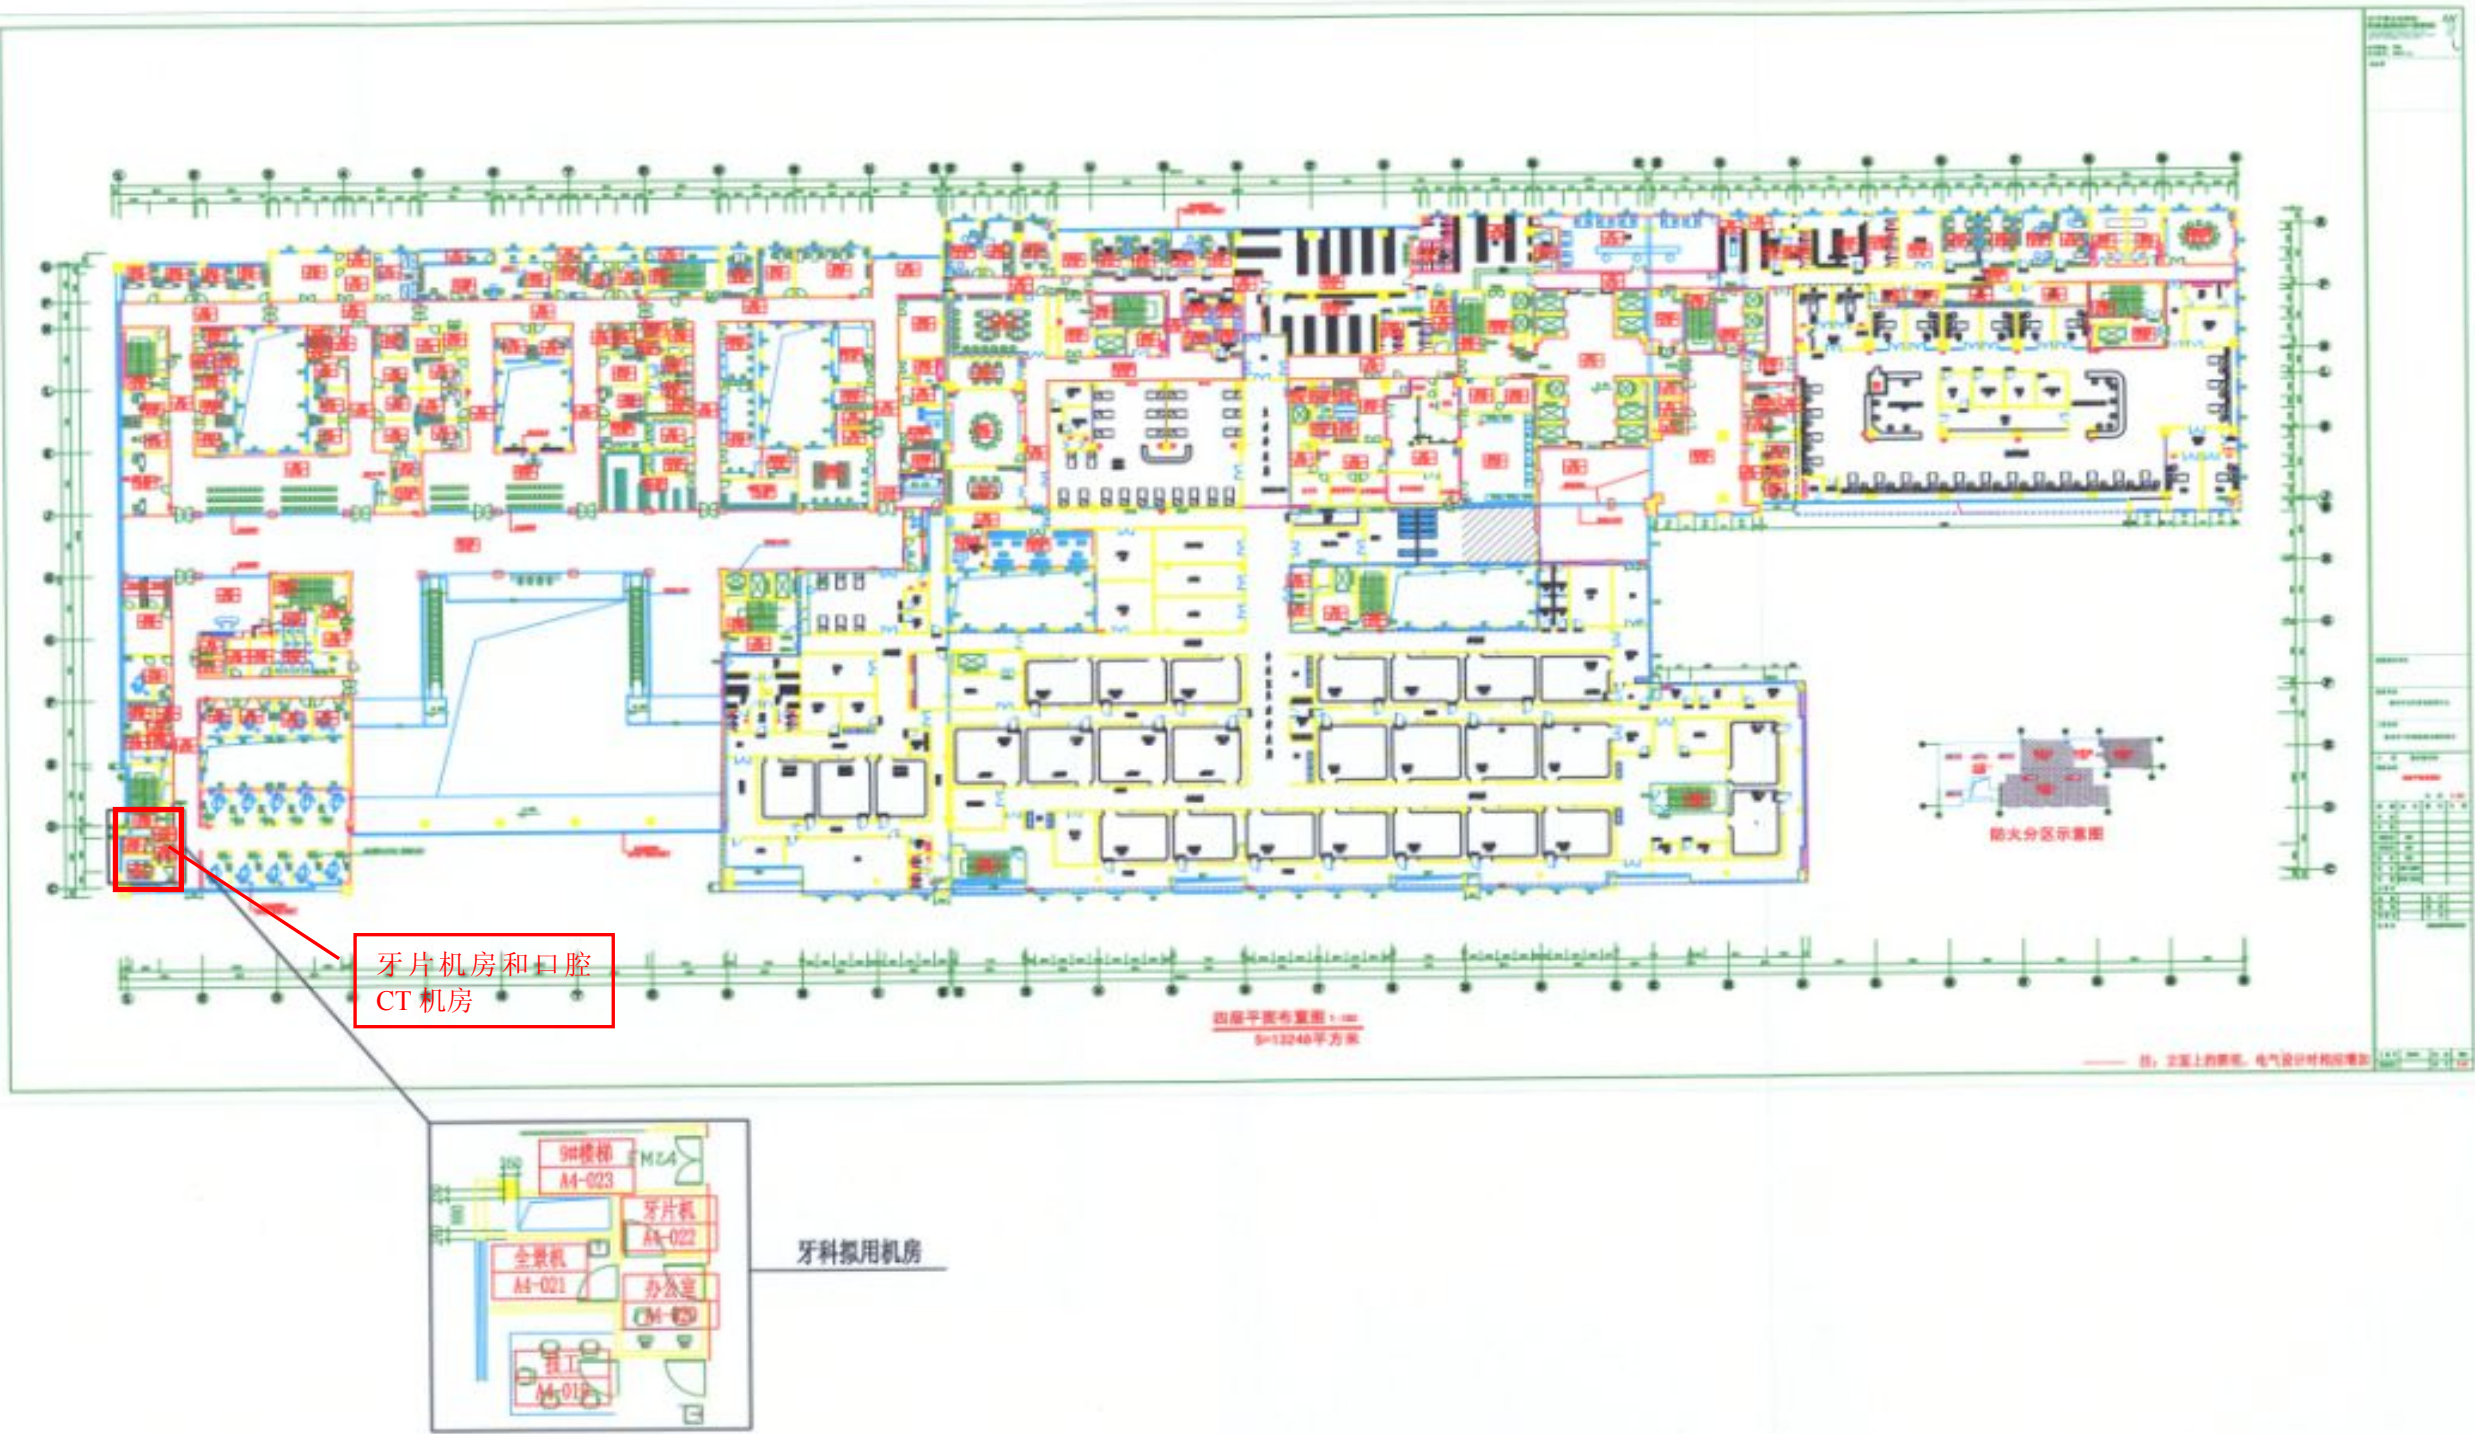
本次验收牙片机房和口腔 CT 机房平面布置图
